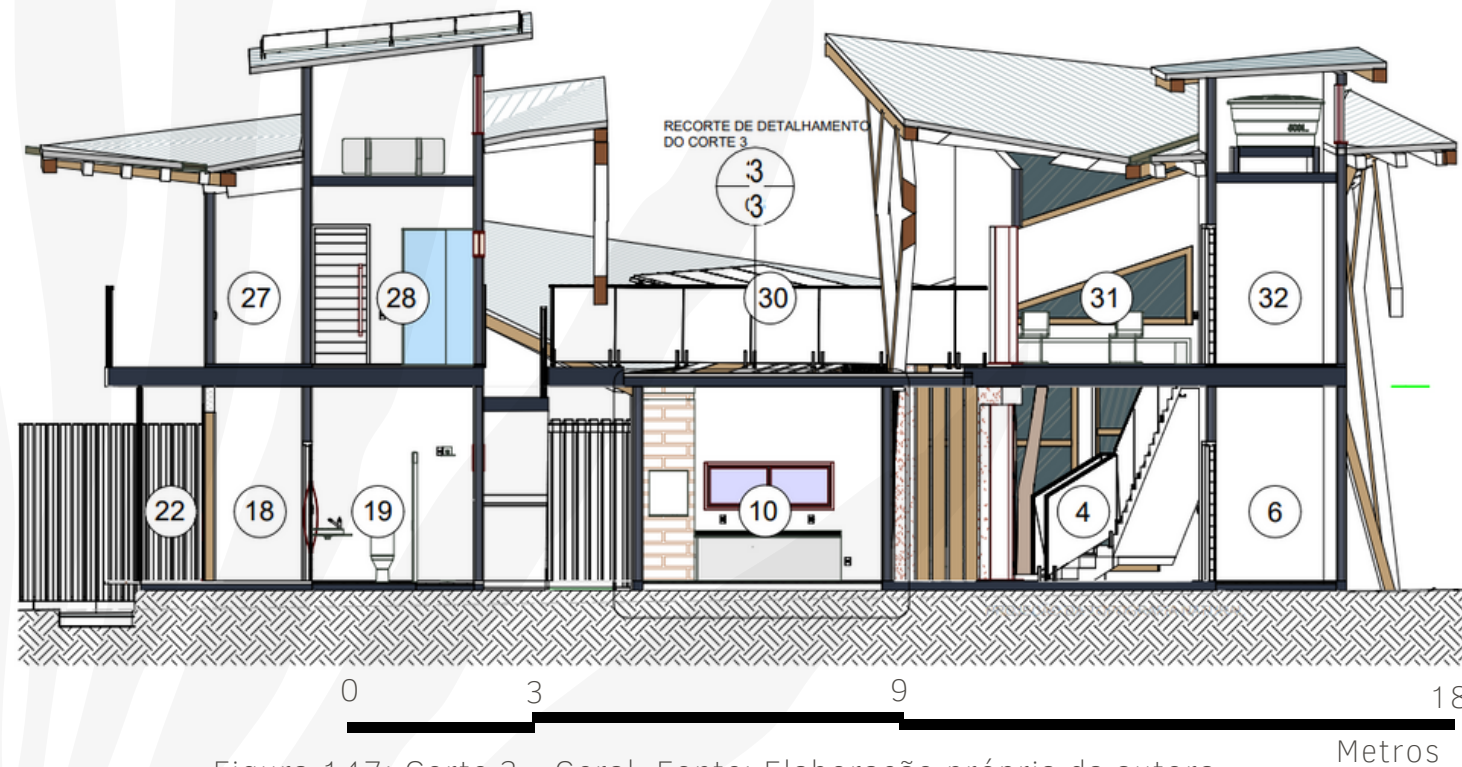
Corte 3 - Geral. Fonte: Elaboração própria da autora.
